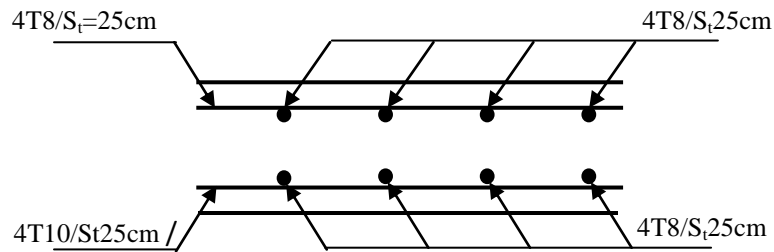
Schéma de ferrailage de la dalle pleine sur quatre appuis
